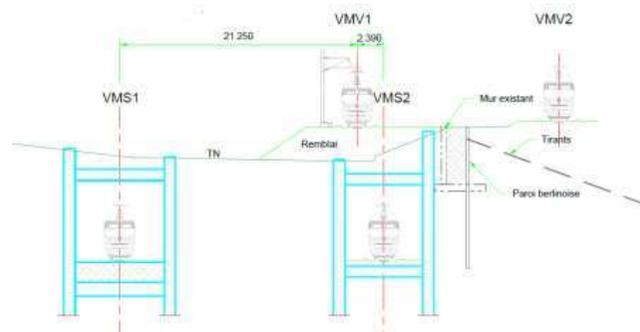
Profil en travers – tranchée couverte (EGIS, 2021)
